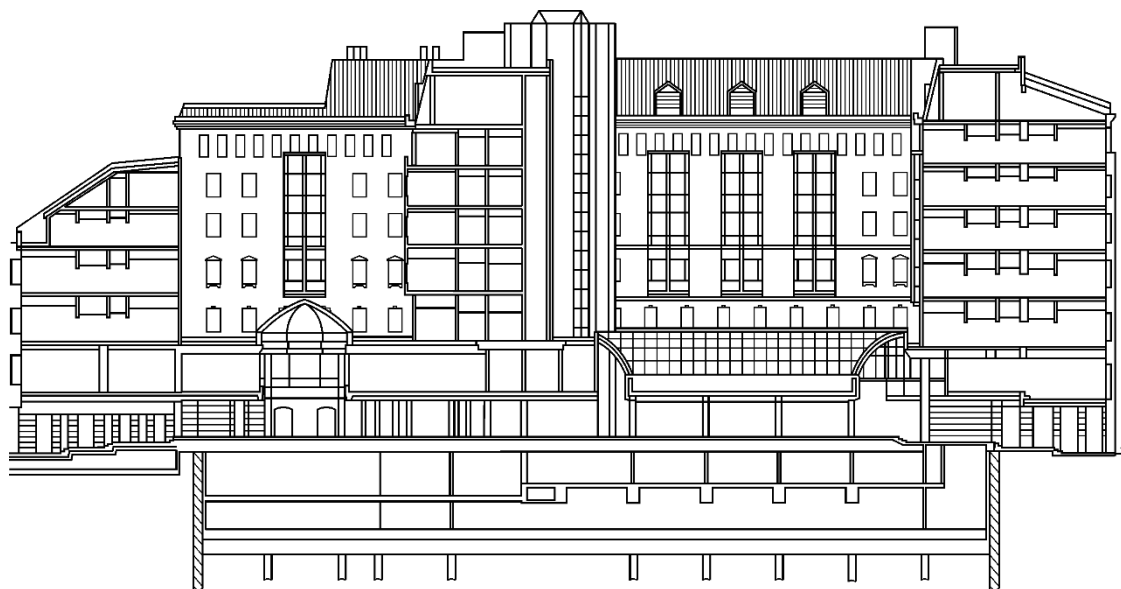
Конструктивный разрез здания с устройством подземной парковки под гостиницей «Невский Палас»
